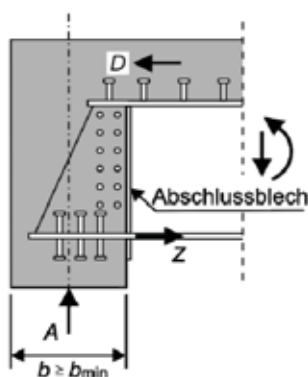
Prefabrikovaný ocelobetonový nosník, varianta E2
